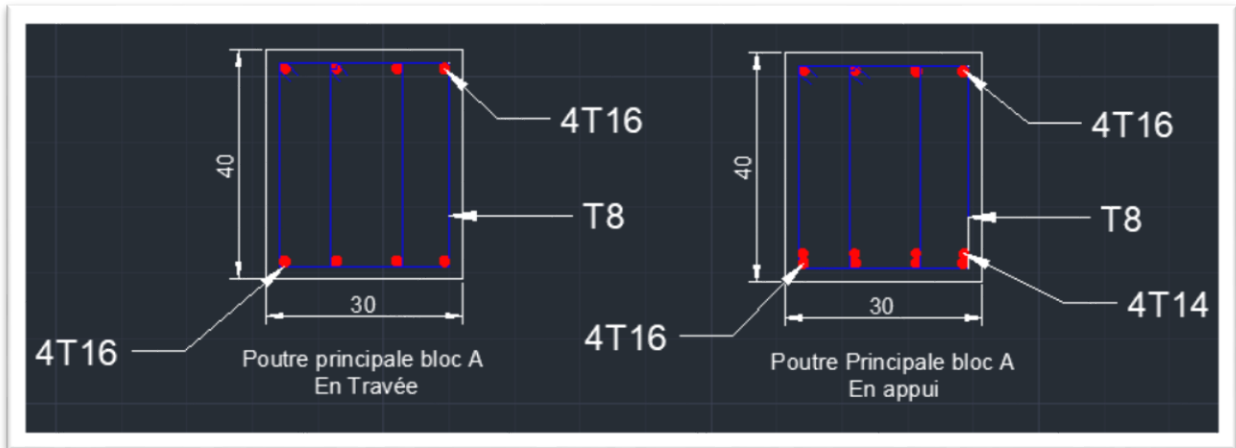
Schéma du ferrailage de la poutre principale du bloc A
